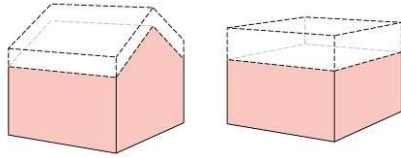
Volumenvergrößerung Dach. Das Dach wird ganzflächig erhöht.
